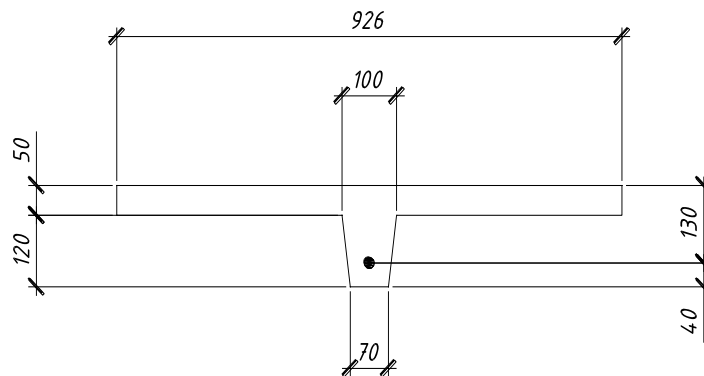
Розрахунковий переріз поперечного ребра плити.
